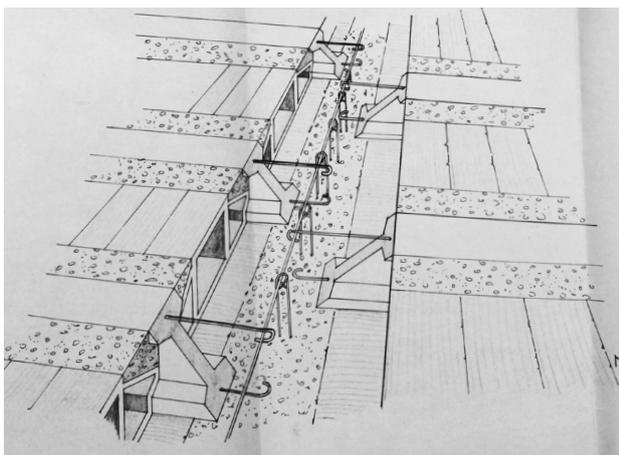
Detalle de forjado formado por viguetas prefabricadas pretensadas. Exp. 60-5-31. Sign. C-031305/008. TIPO I.
